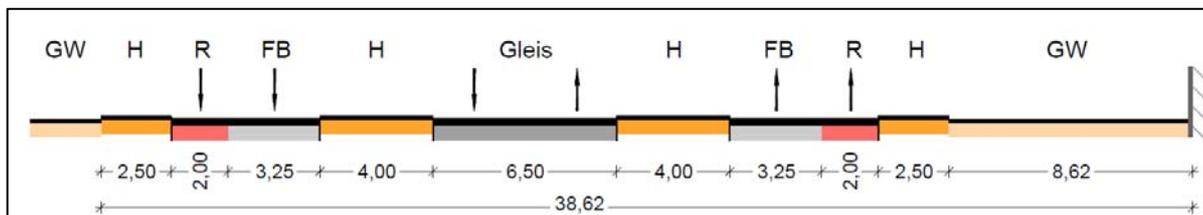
Hauptvariante 2, BS geplanter Querschnitt Haltestelle Stadthalle (Angaben in Meter), Quelle: Voruntersuchung
